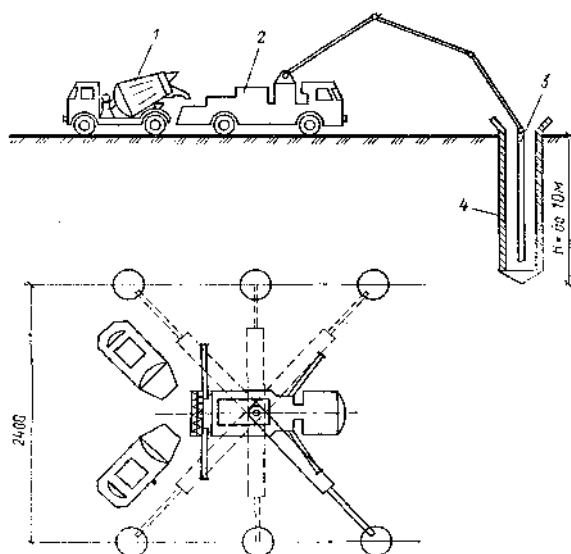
Бетонирование набивных свай напорным методом с помощью распределительной стрелы автобетононасоса: 1 -
